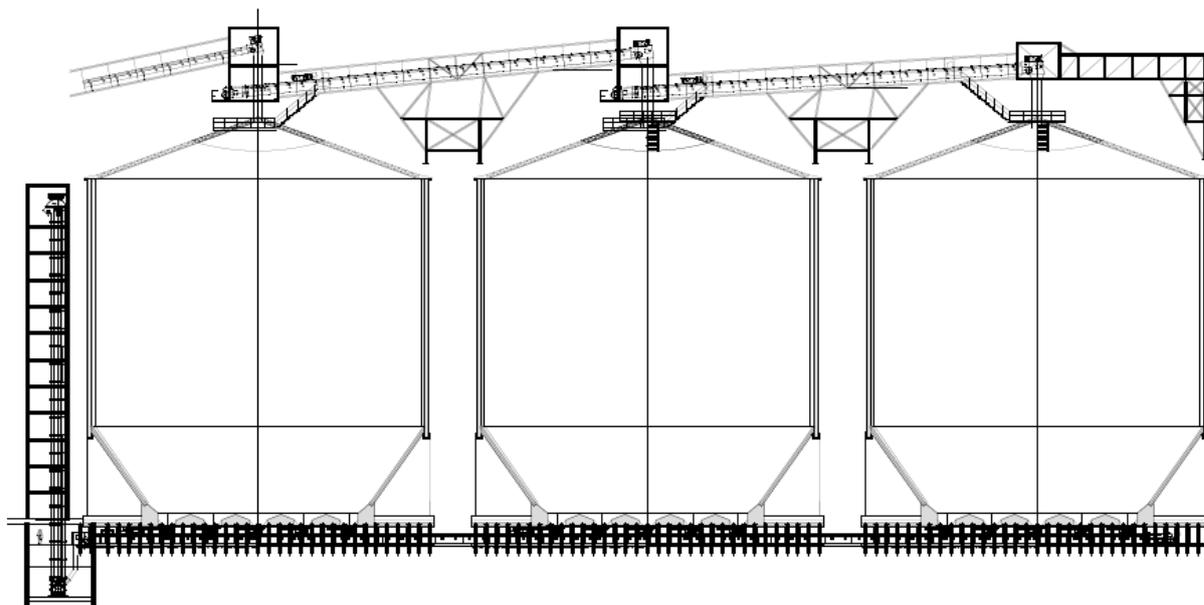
Bateria de Três Silos Verticais de Concreto
